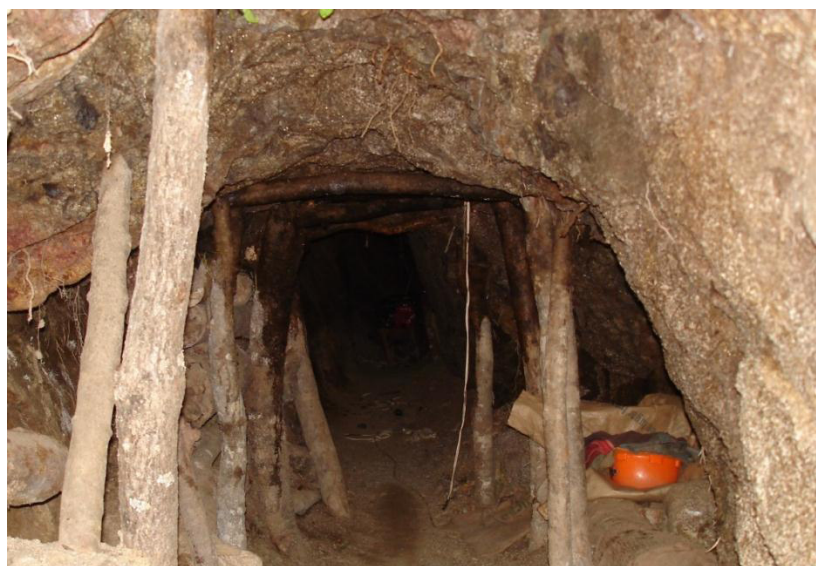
Labor de acceso y extracción de mineral. Vista de interior
